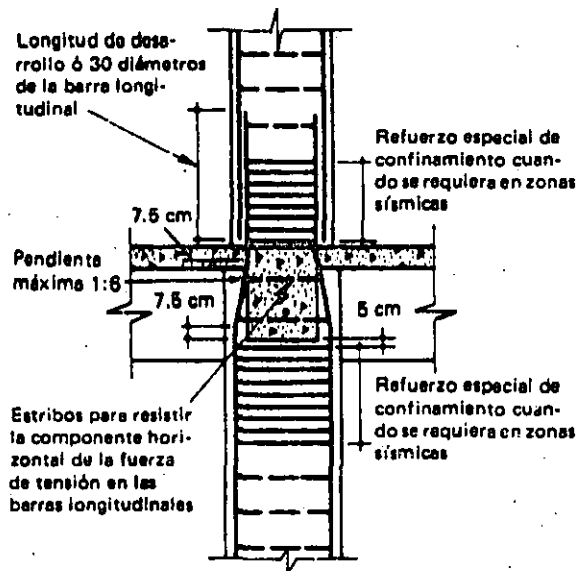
Detalles del refuerzo en los cambios de sección de columnas.
